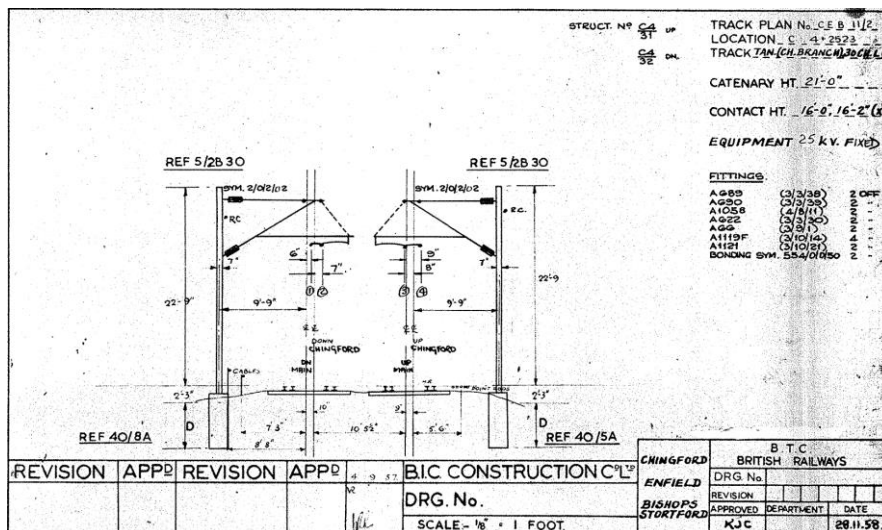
Planos de las estructuras C/04/31 y C/04/32
